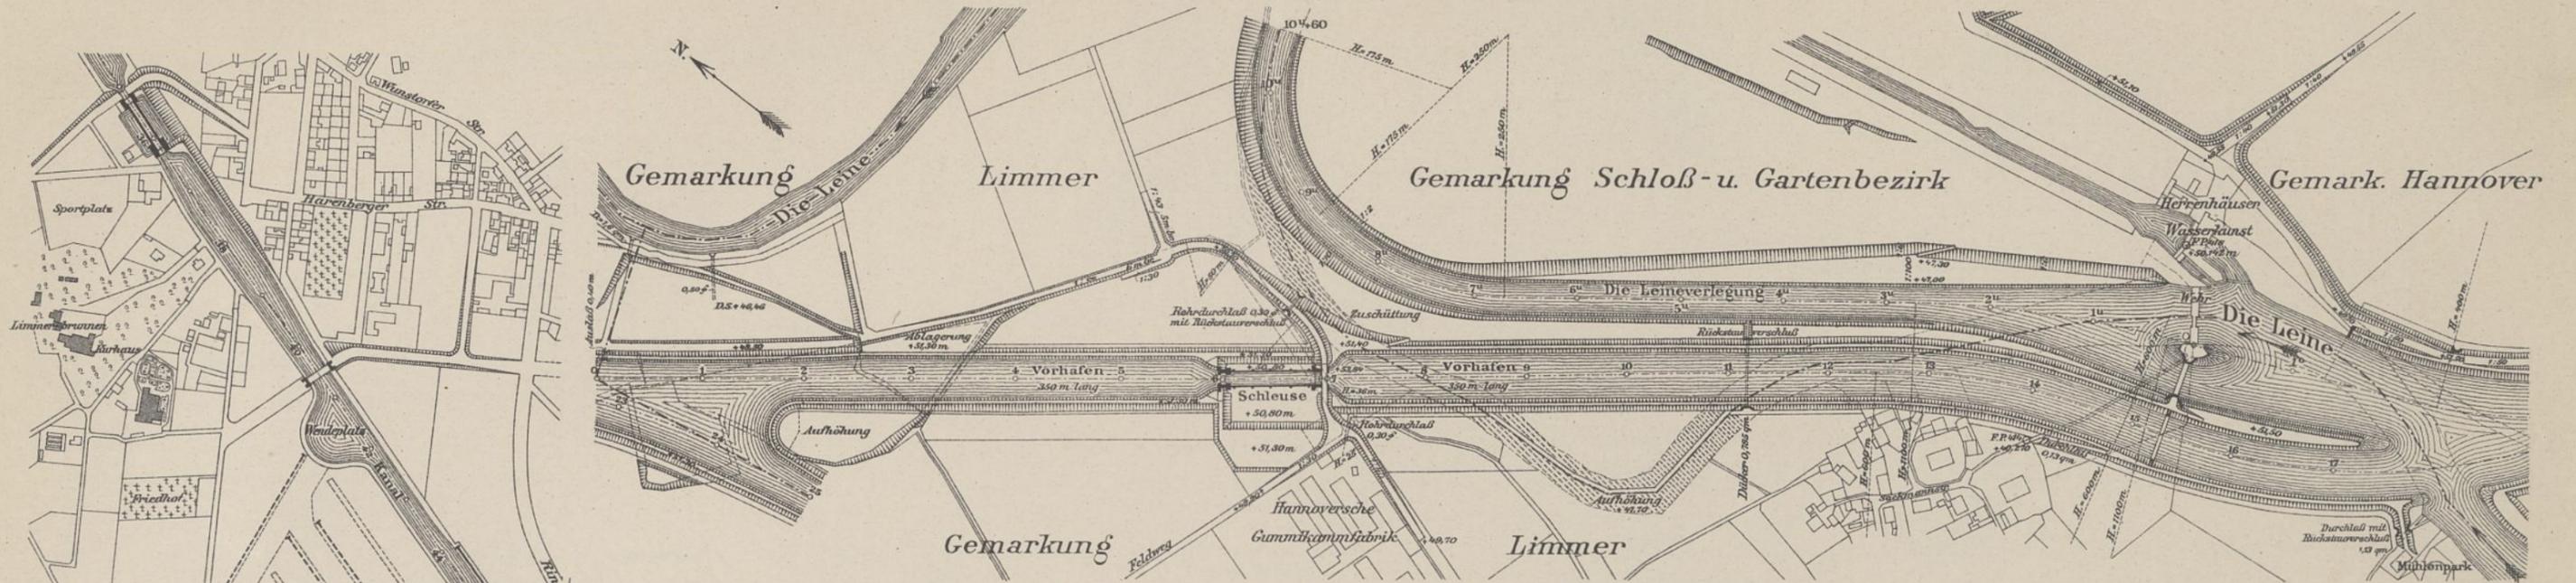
Lageplan Leineabstiegskanal. 1: 6000.
